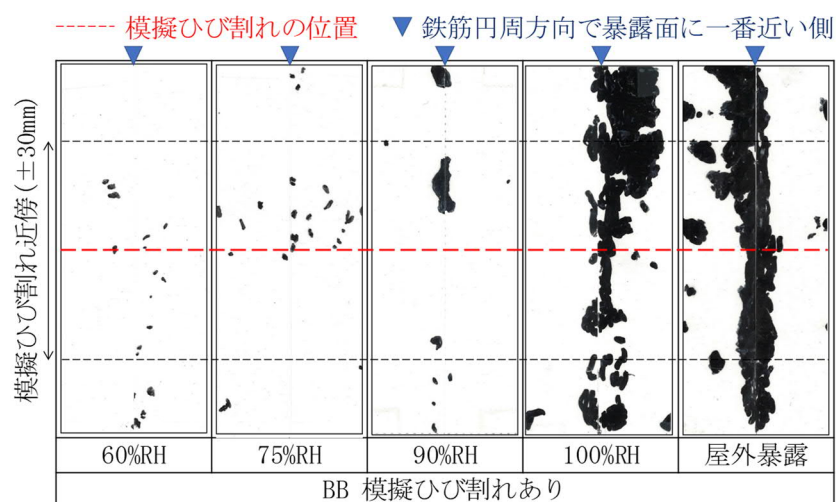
暴露試験終了時の鉄筋表面の鉄筋腐食箇所のトレース結果（BB／模擬ひび割れあり）
